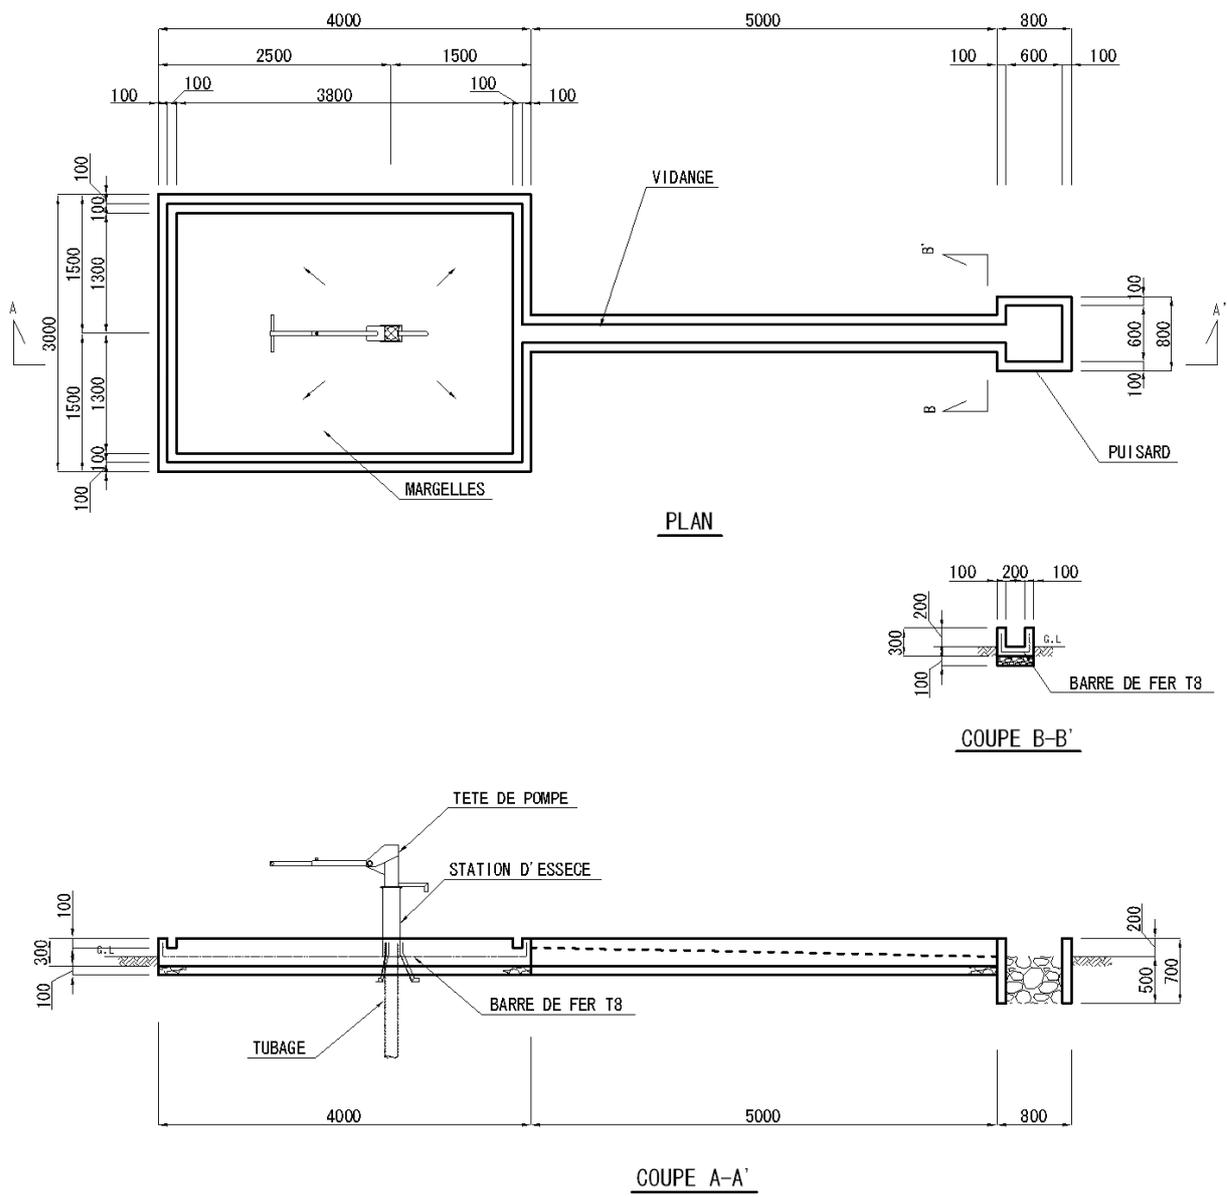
Plan structural standard d'ouvrage à pompe manuelle
